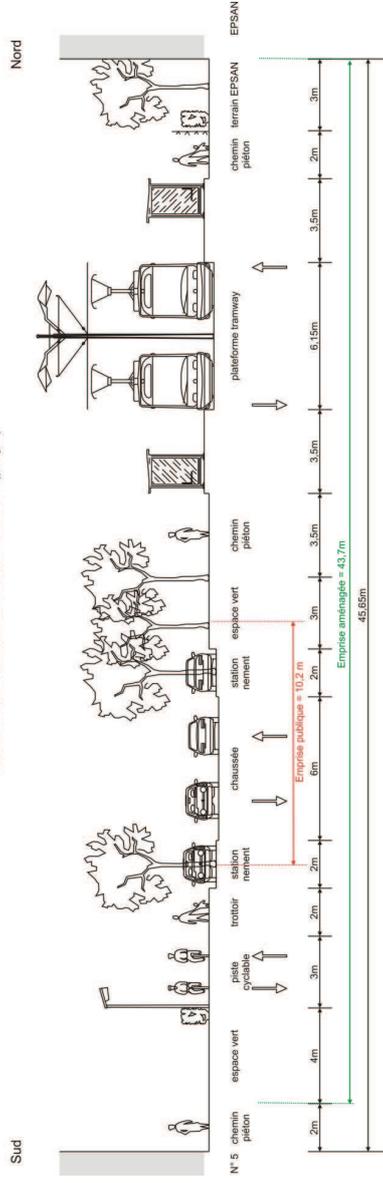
Situation projetée (coupe 10) sur la rue Einstein
